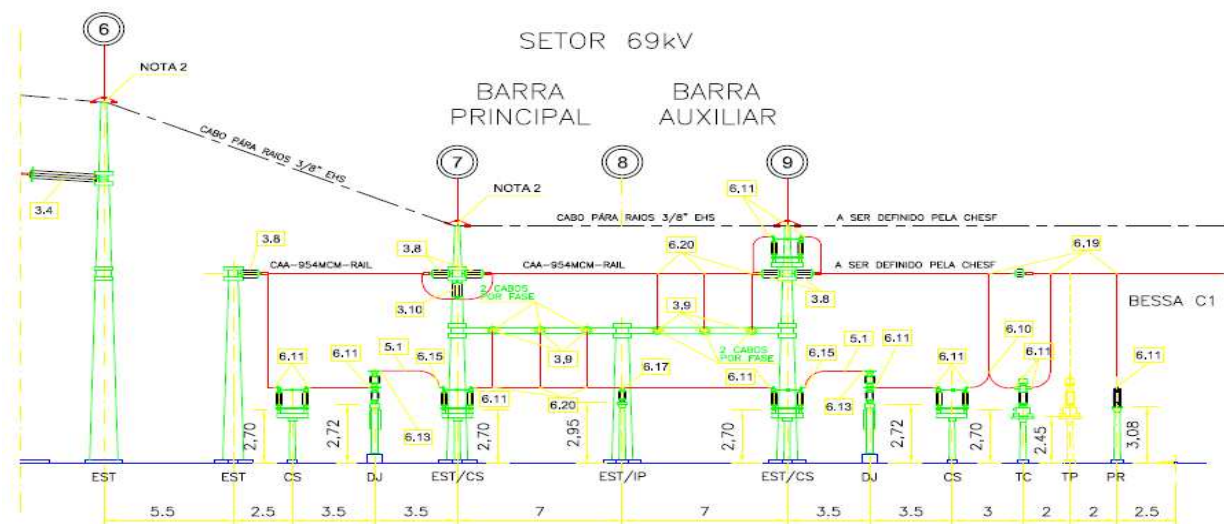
Subestação Santa Rita II – Interligação de barras e Barramento 69 kV atual
